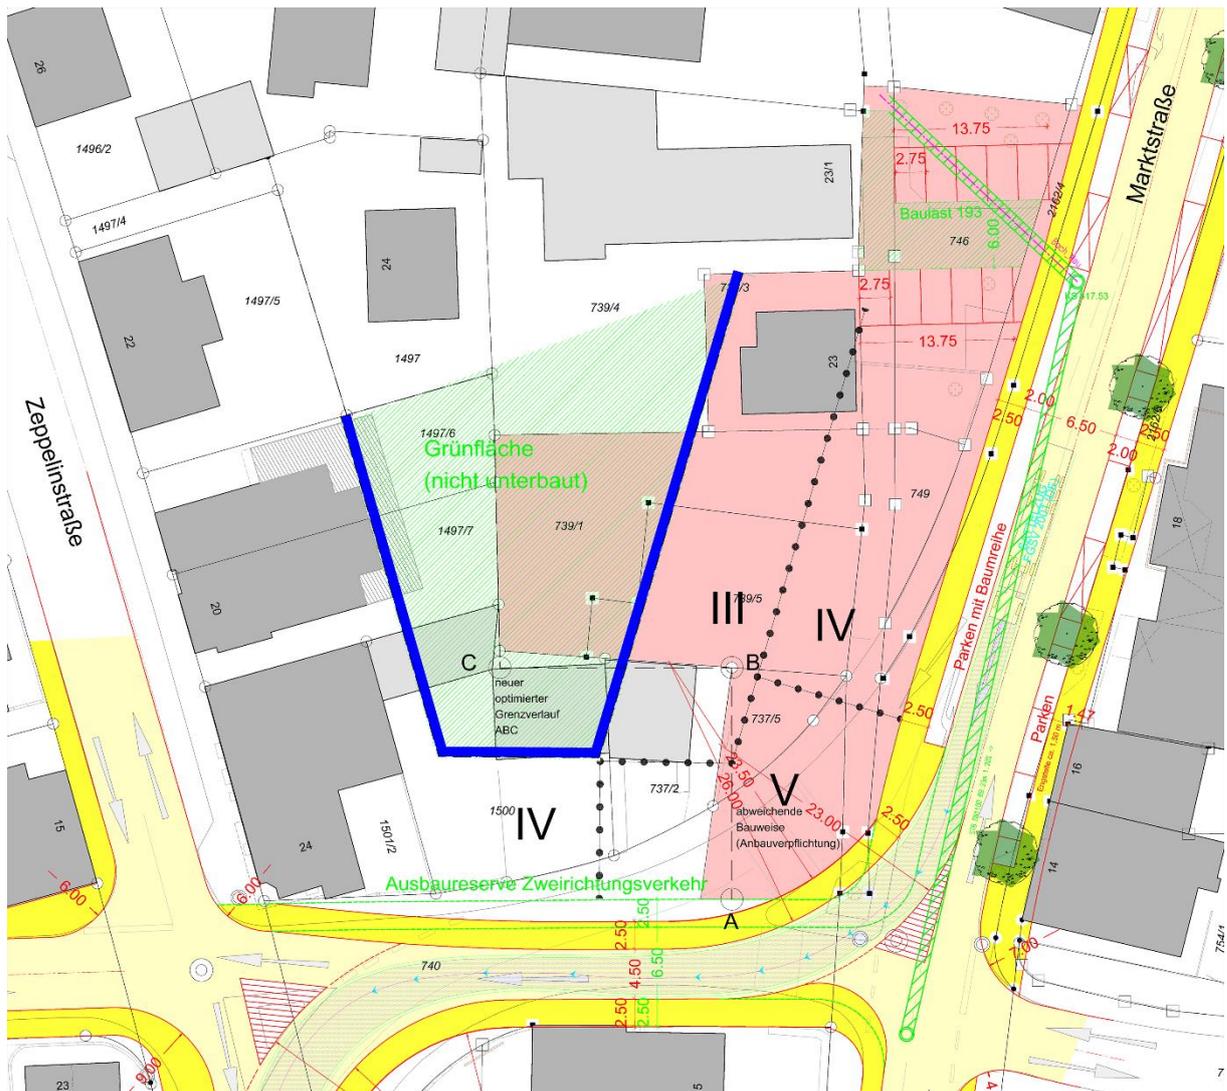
Planungsrechtliche Überlegungen in Vorbereitung auf einen möglichen Bebauungsplan, Quelle: Stadt Pfullingen auf Grundlage von Herrmann und Mang Ingenieure, 2019
